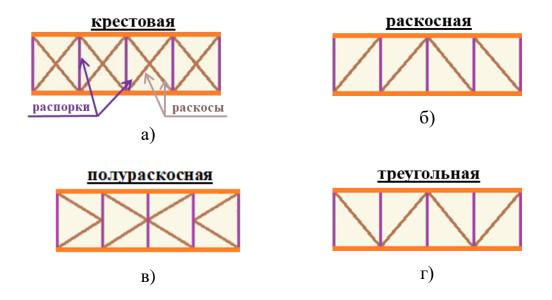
Схемы решеток связевых ферм а) крестовая с дополнительными стойками, б) – раскосная, в) полураскосная. г) треугольная
